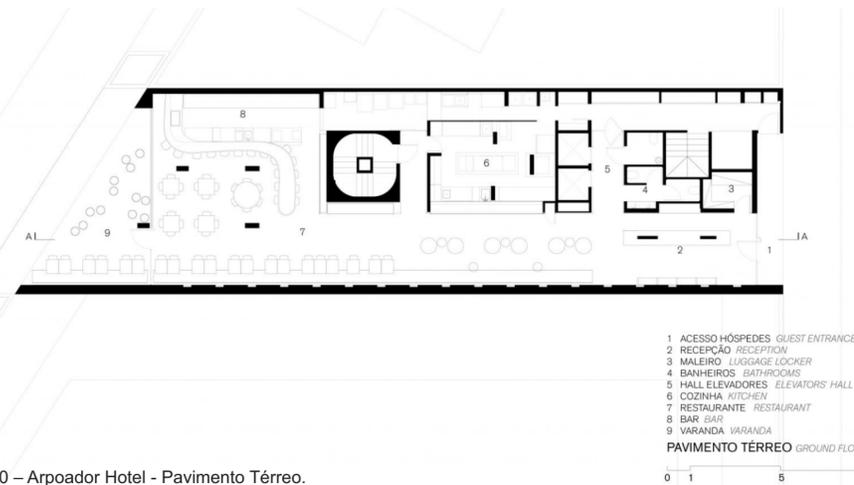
Arpoador Hotel - Pavimento Térreo.
